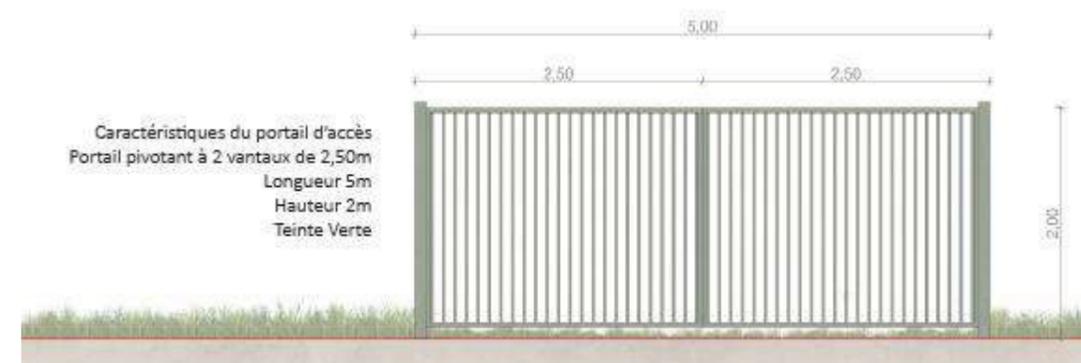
Caractéristiques du portail d'accès (Source : Permis de construire EDF Renewables)
